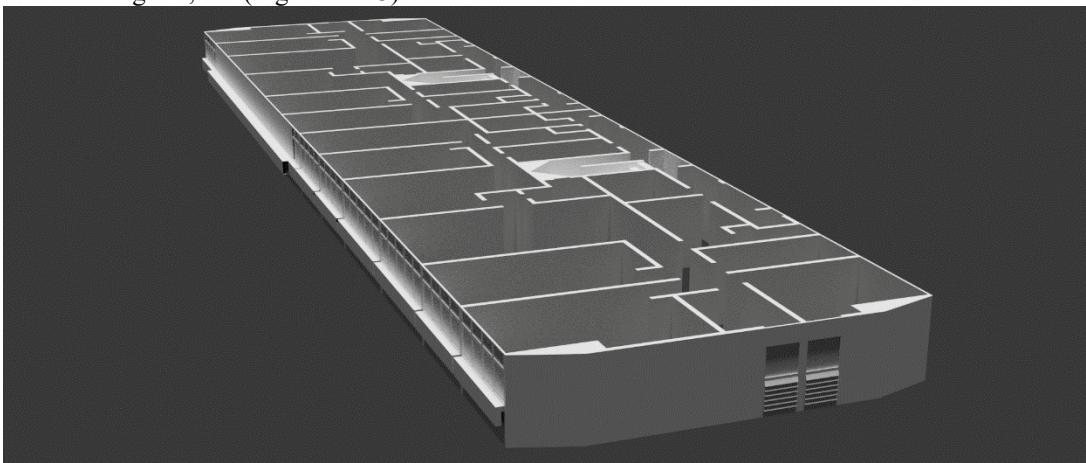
Modelagem inicial do pavimento do edifício. Renderização inicial de teste.
